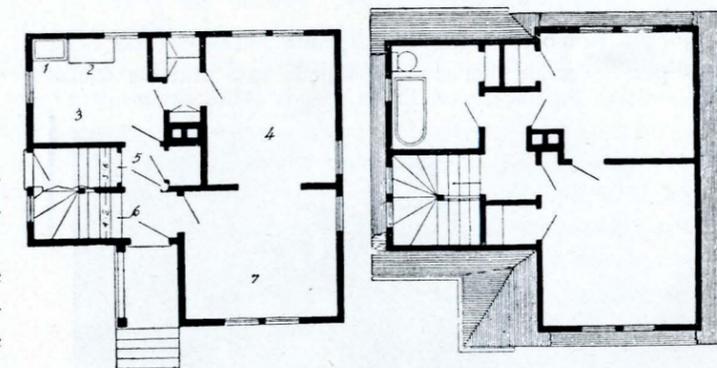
Pianta del piano terreno e del primo piano di una casetta costruita dalla « Niagara Development Company ».
